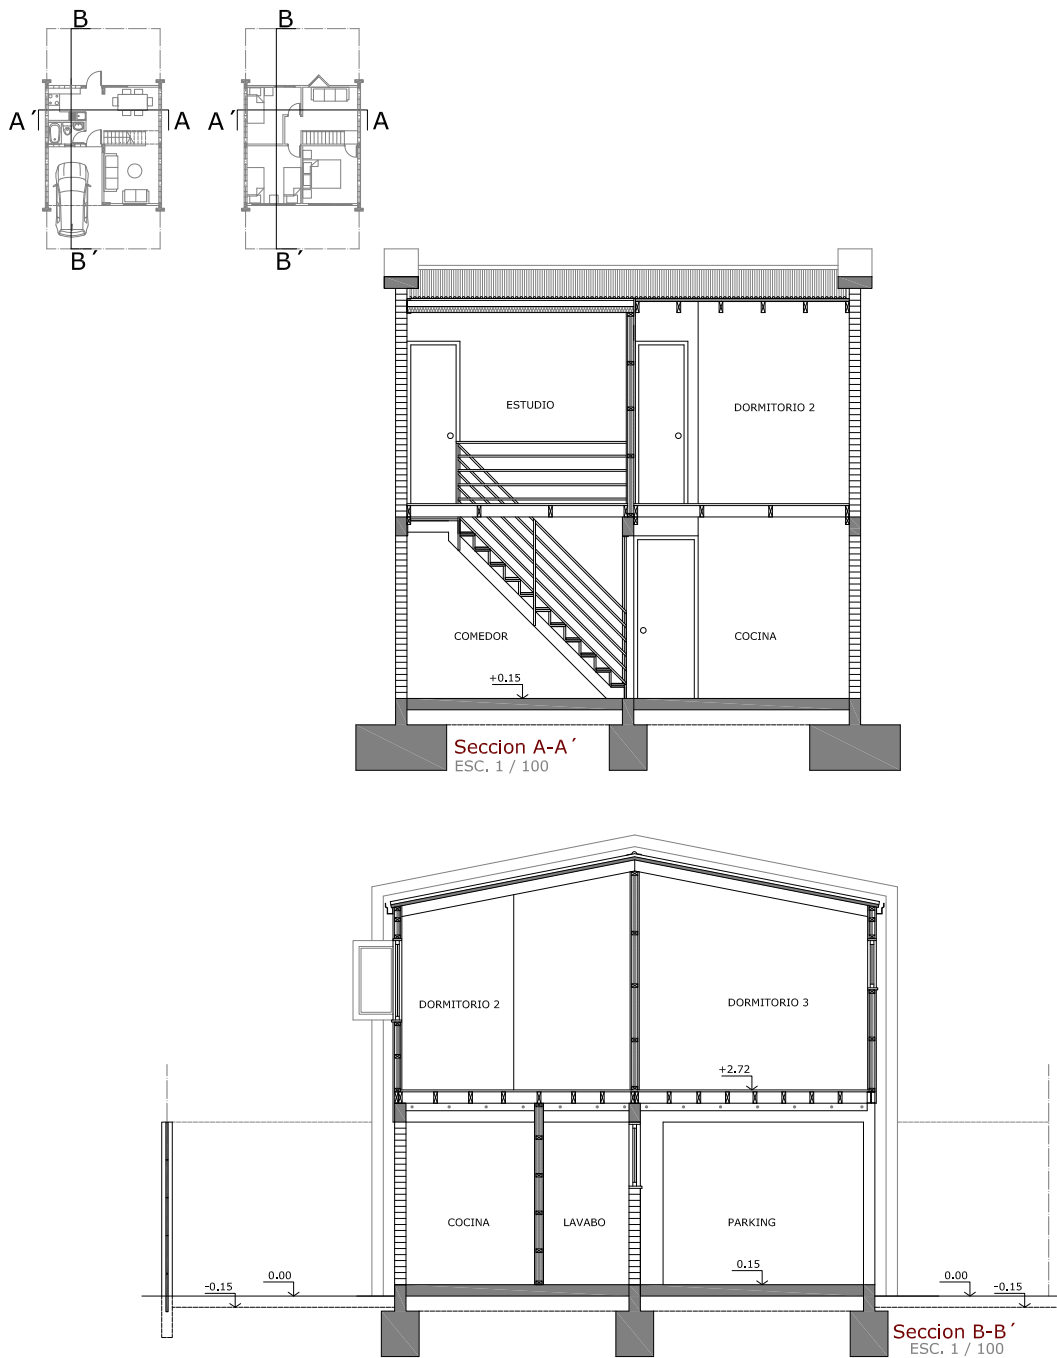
Secciones A-A' y B-B' (soporte arquitectónico final ,1ª y 2ª etapa)
